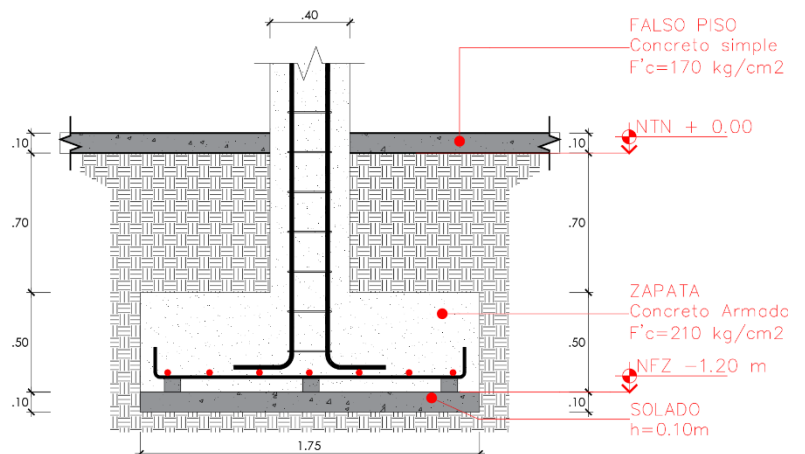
Detalle de zapata (suelo estabilizado) - Corte Z2.
